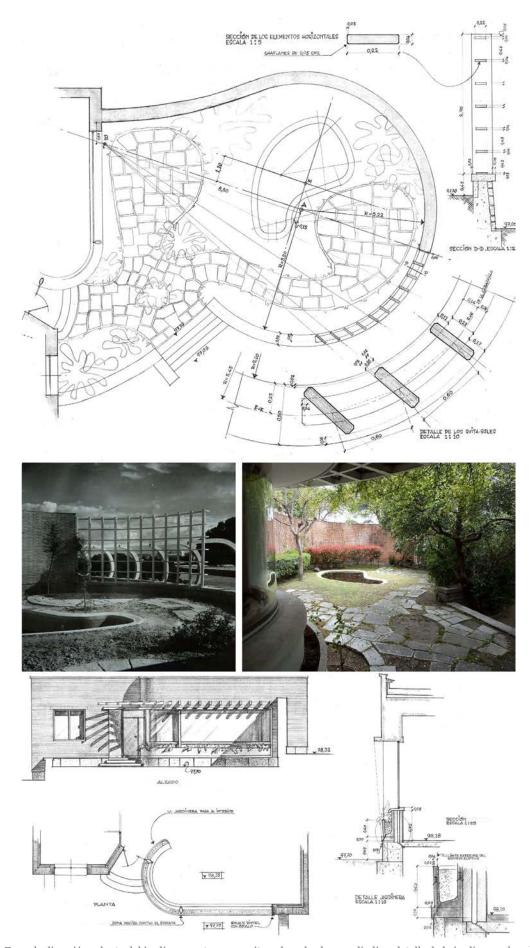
Zona de dirección: planta del jardín con estanque, quita-soles, alzado a mediodía y detalle de la jardinera adosada al muro, (Archivo del ITCC, tubo V-205 y nº 210).
